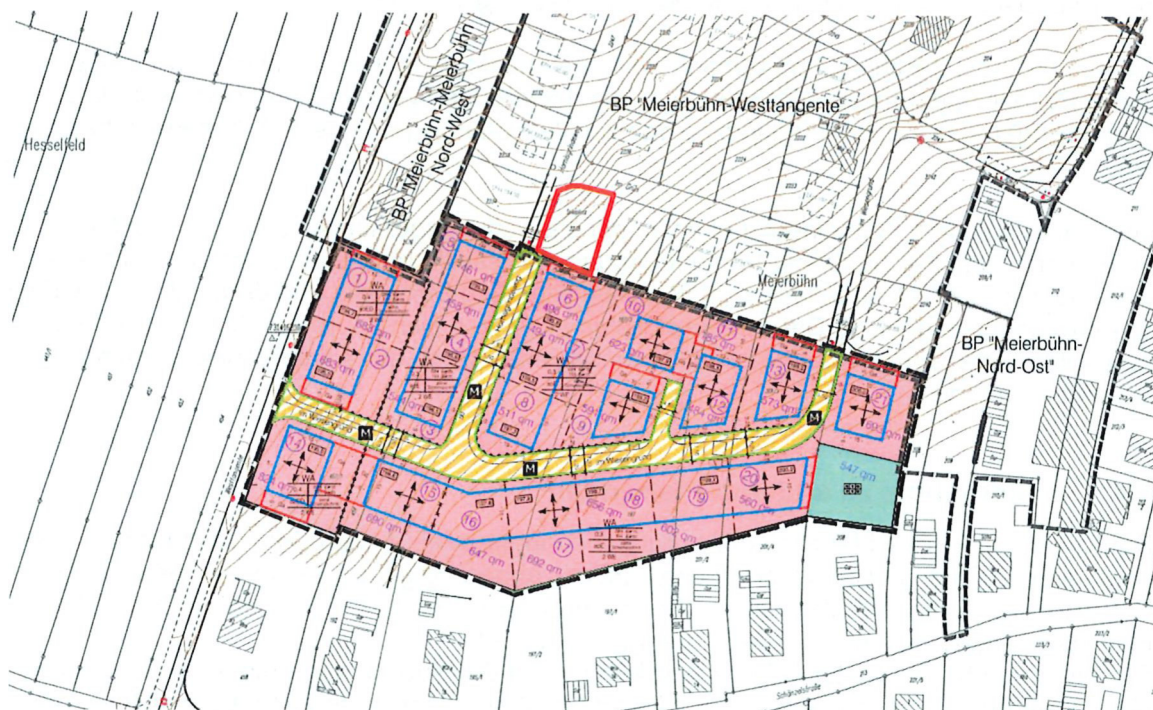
Planzeichnung des Bebauungsplans "Meierbühn-Westtangente II" aus dem Jahre 2012 (Auszug) mit Darstellung des Änderungsbereichs; Quelle: Zink Ingenieure, eigene Darstellung
